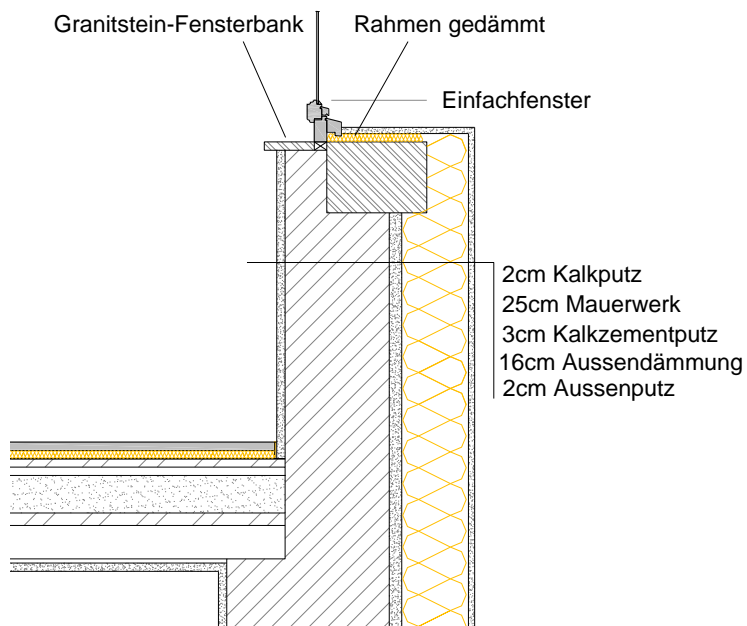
Fensteranschlussdetail Brüstung bei Einfachfenster mit Aussenwärmedämmung und Leibungsdämmung
